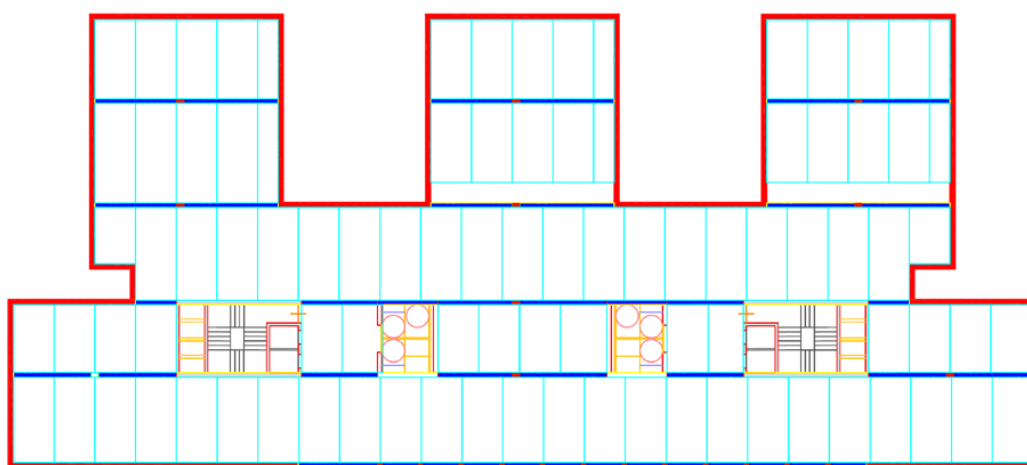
Planta de la estructura indicando los elementos principales de esta.
